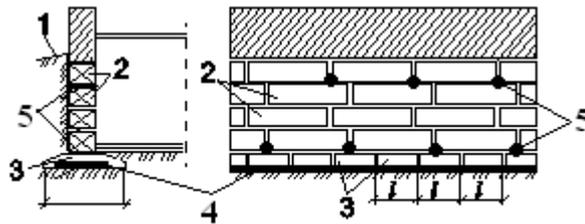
Столбчатый фундамент с АНК под стену
